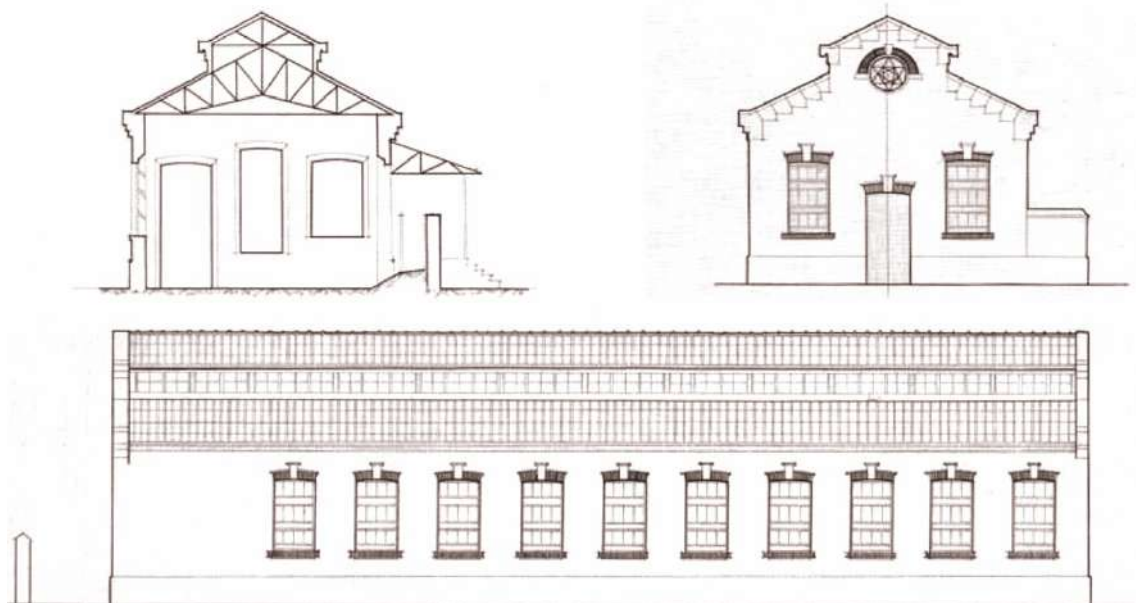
Alzados y sección transversal de la nave de ganado vacuno. Fuente: Archivo Municipal (Sec. B, Leg. nº 78/32).
